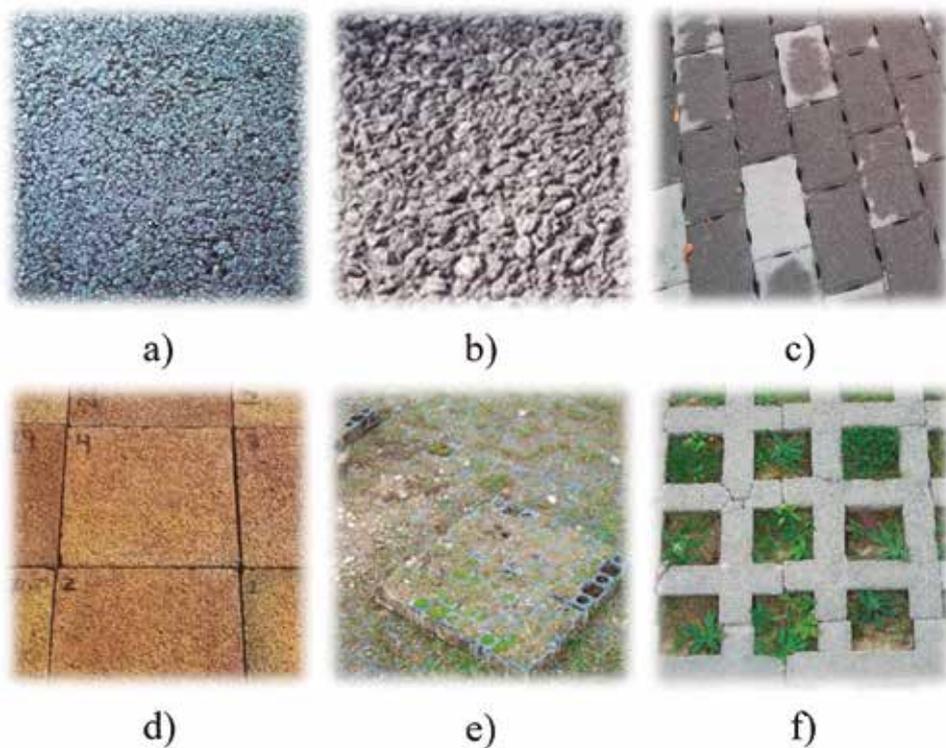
Tipos de superficie en pavimentos permeables a) Asfalto poroso b) Hormigón poroso c) Adoquines impermeables con juntas abiertas d) Adoquines de hormigón poroso e) Césped reforzado con celdas de plástico f) Césped reforzado con celdas de hormigón
